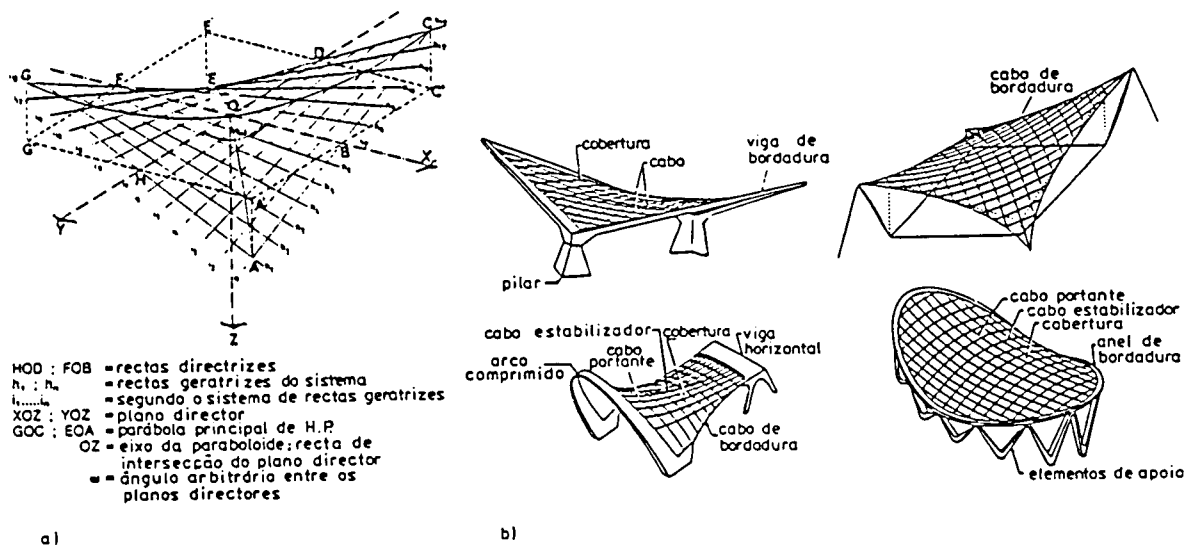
a) Porção de uma superfície H.P.; b) exemplos de superfícies H.P.
